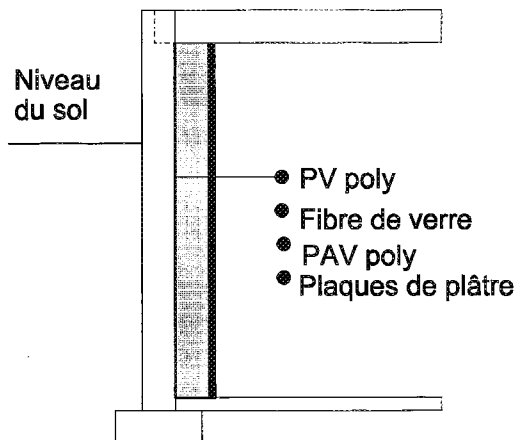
Panneau d'essai 2 – Mur ordinaire, PAV derrière les plaques de plâtre et contre le mur du sous-sol.
